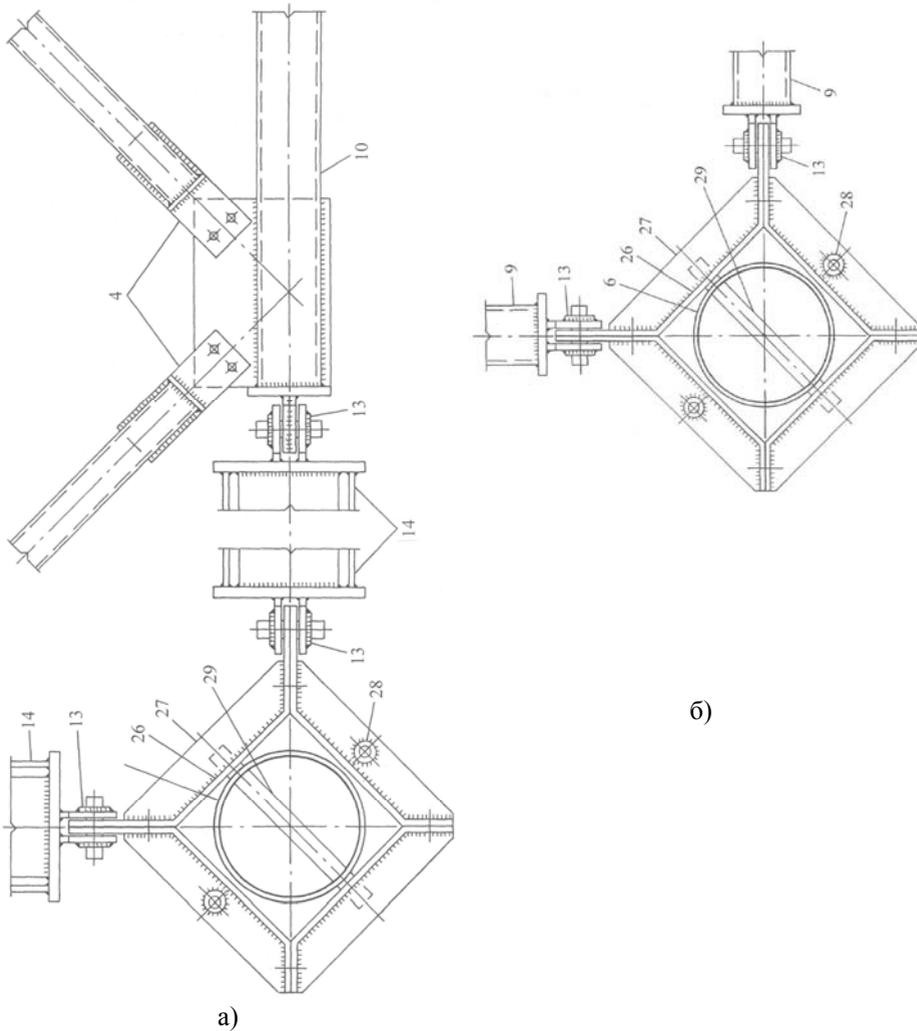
Схематичные виды сверху узлов сопряжения нижних поясов (а) и верхних поясов (б) контурных ферм с угловой колонной:
